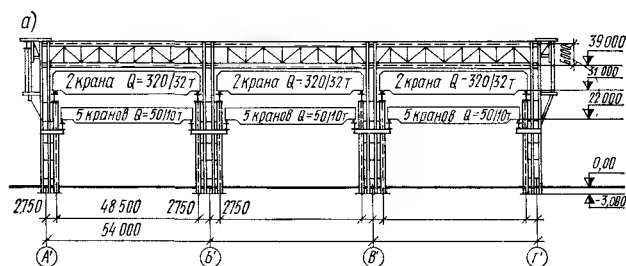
Схема каркаса сборочно-сварочного цеха с двухъярусным расположением кранов
